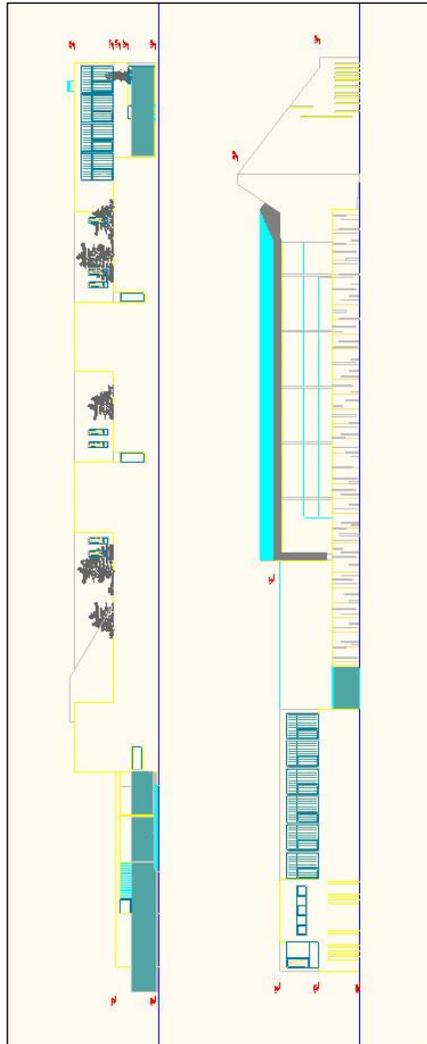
Alzados, Año 2005, Fuente proyecto de Ejecución
